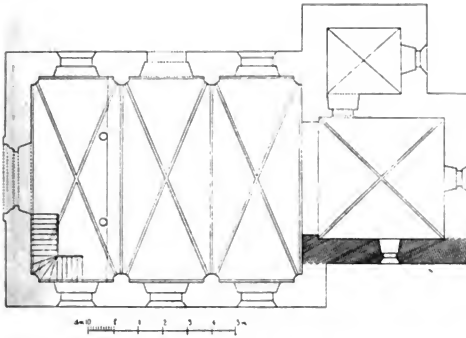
Hradsko. Grundriss der Kirche.
